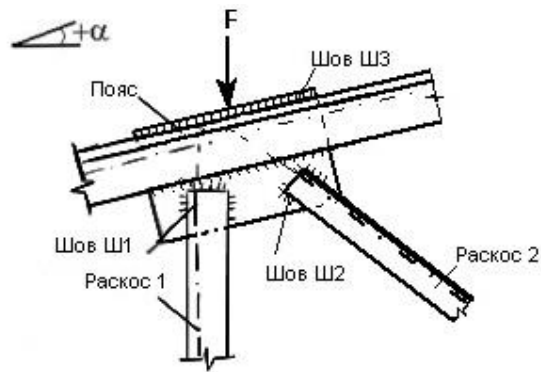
«Конструкторский чертеж узла номер 9» [10]
